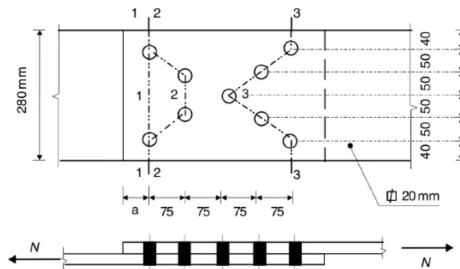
Chapas metálicas tracionadas conectadas por parafusos.
